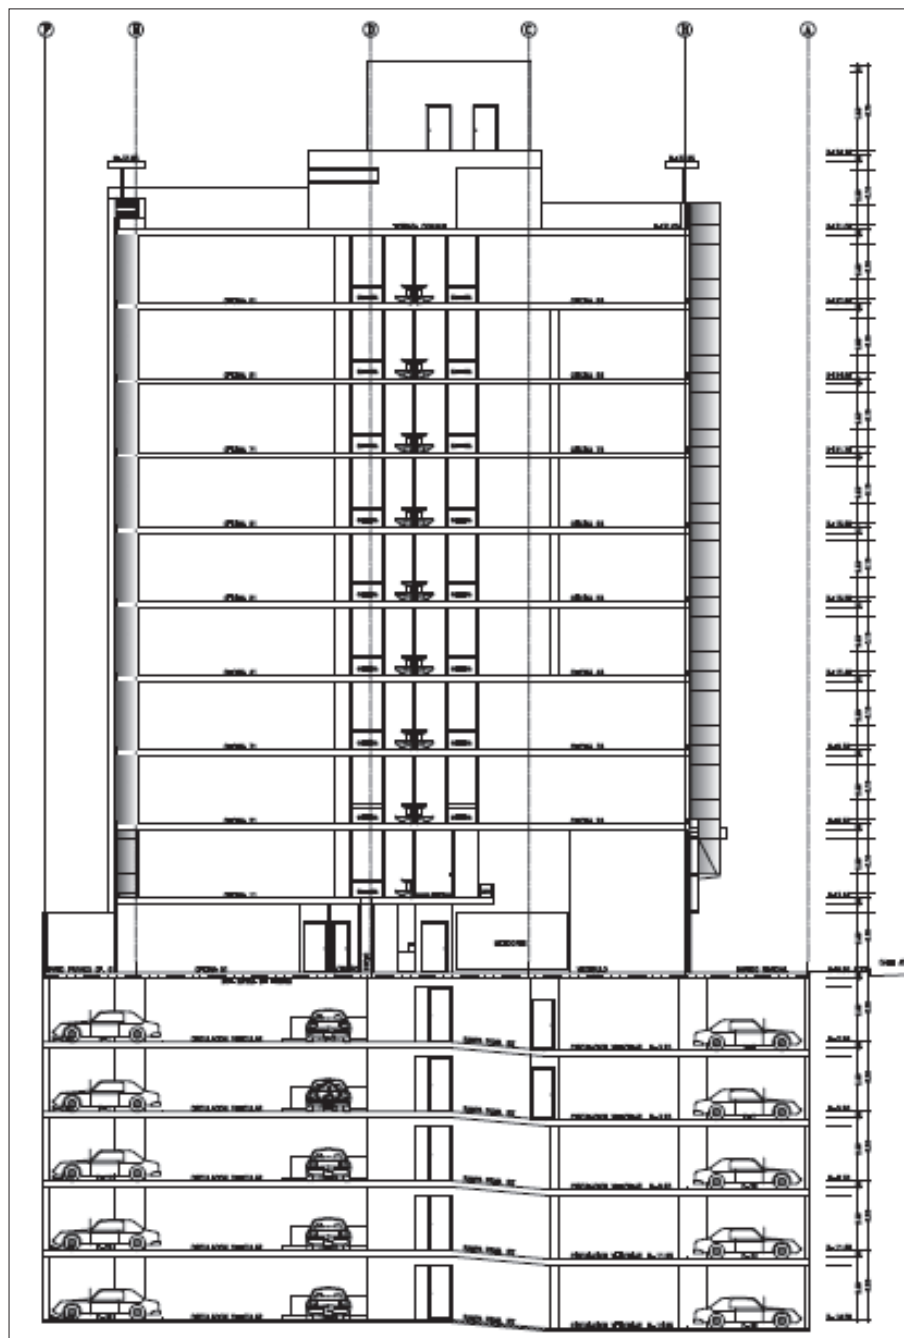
PLANTA ARQUITECTÓNICA DEL EDIFICIO PLUS I
